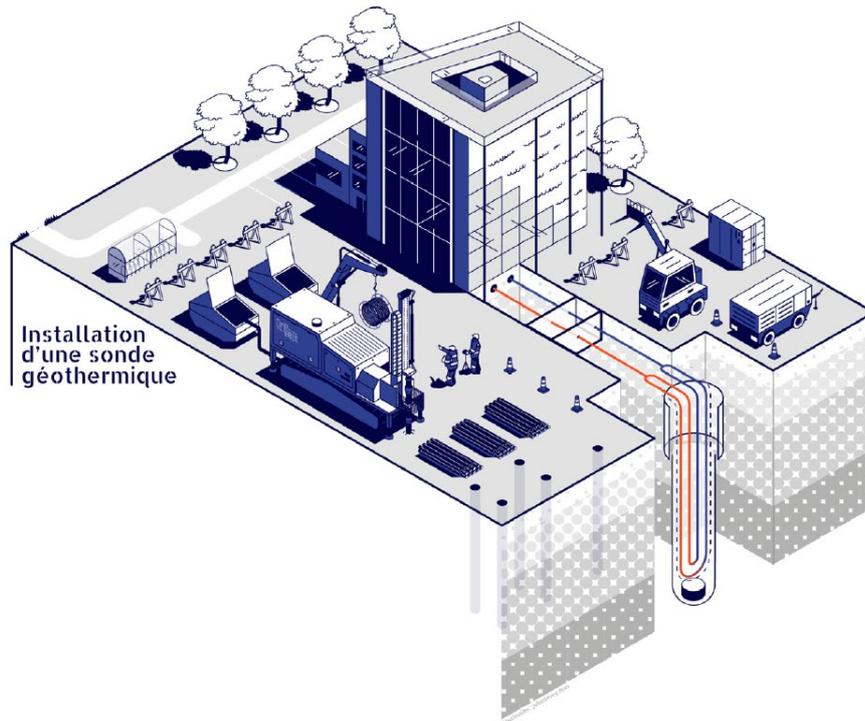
Schéma de principe d'un chantier d'installation de sonde géothermique par DrillHeat (source : Arverne Group)
